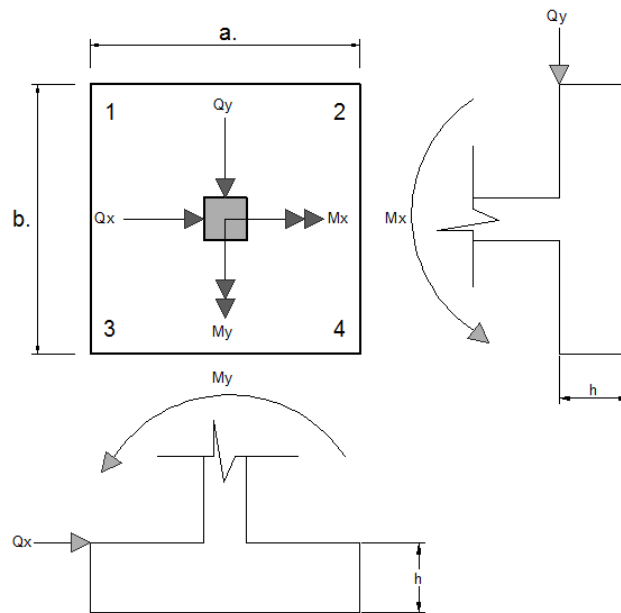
Esquema de la Zapata Centrada; Elaboración Propia
